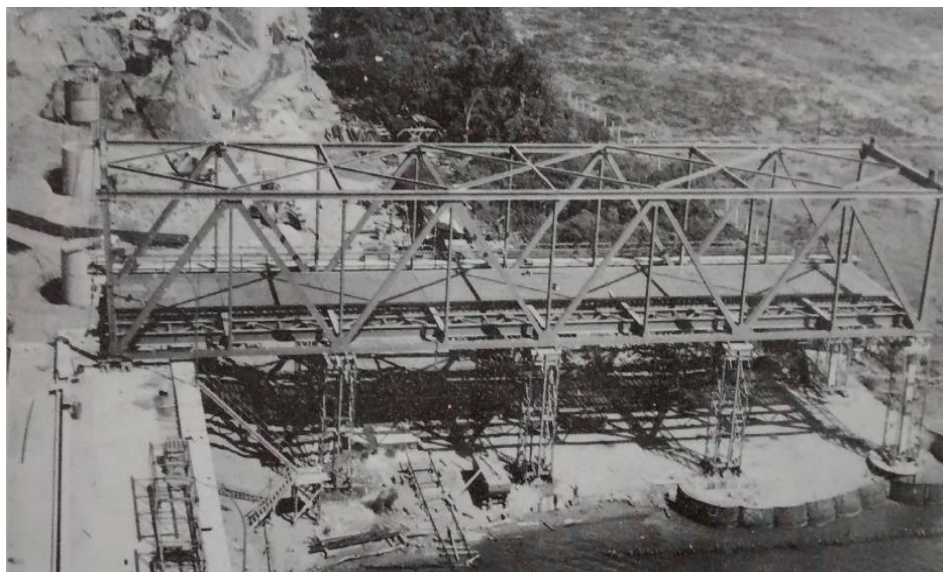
Construcción de la armadura metálica a orillas del margen izquierdo del río [1.2].
